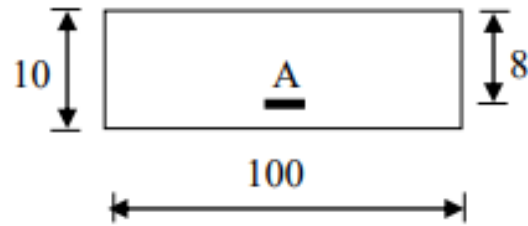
Section de calcul du ferrailage de l'acrotère
